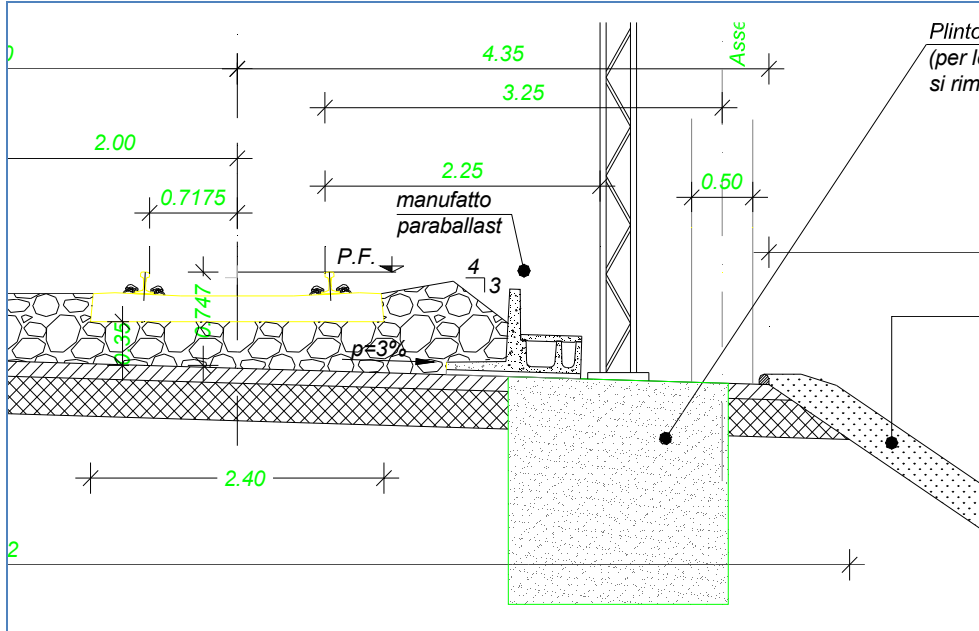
Sezione in rilevato-particolare drenaggio al ciglio: canaletta porta-cavi, cordolo, embrici
